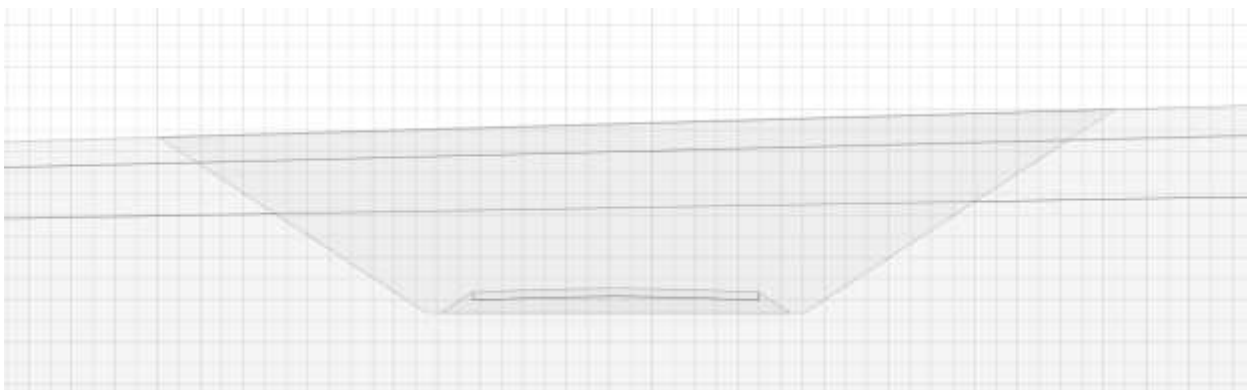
Импорт поперечного сечения дорожной выемки с грунтовым основанием в PLAXIS 2D в режиме Structures
